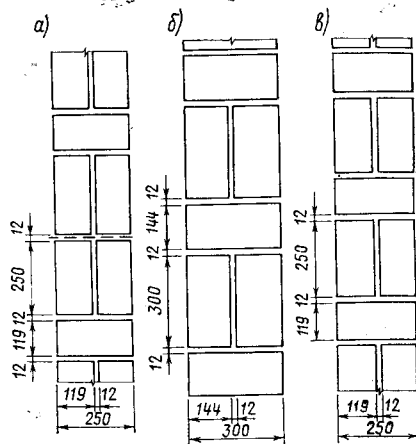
Типы кладок стен из мелких ячеистобетонных блоков толщиной
